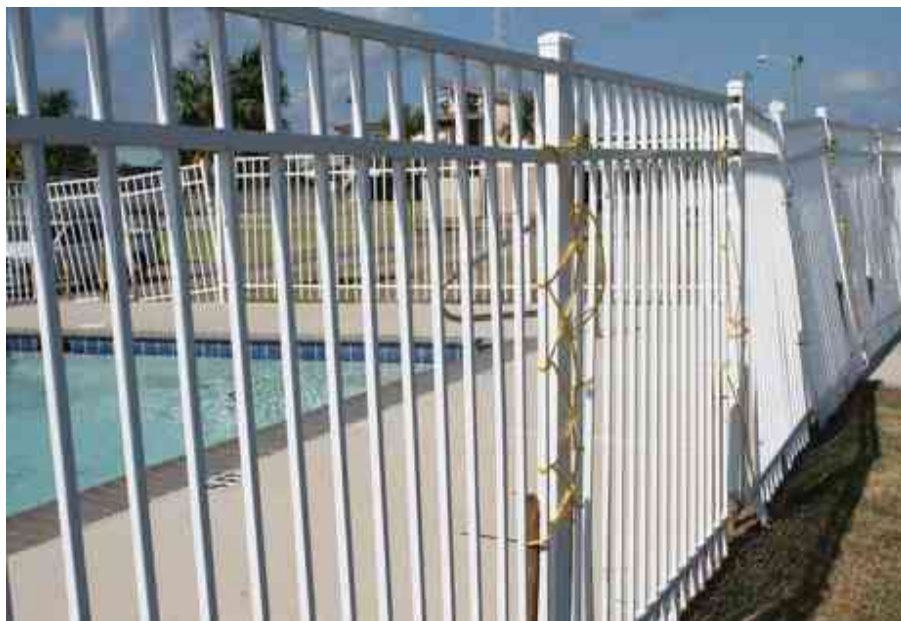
Barandal perimetral de la piscina. Autor: JAPG.
